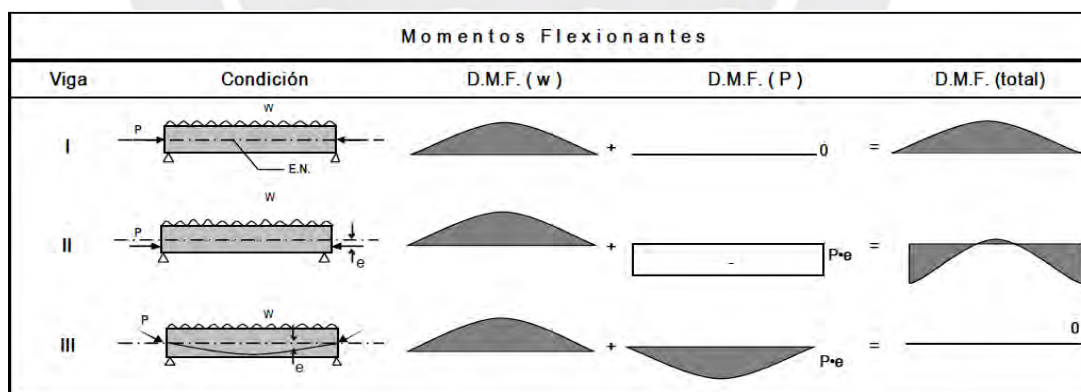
Momentos flexionantes a lo largo de vigas preesforzadas simplemente apoyadas (Reinoso et al, 2000)
